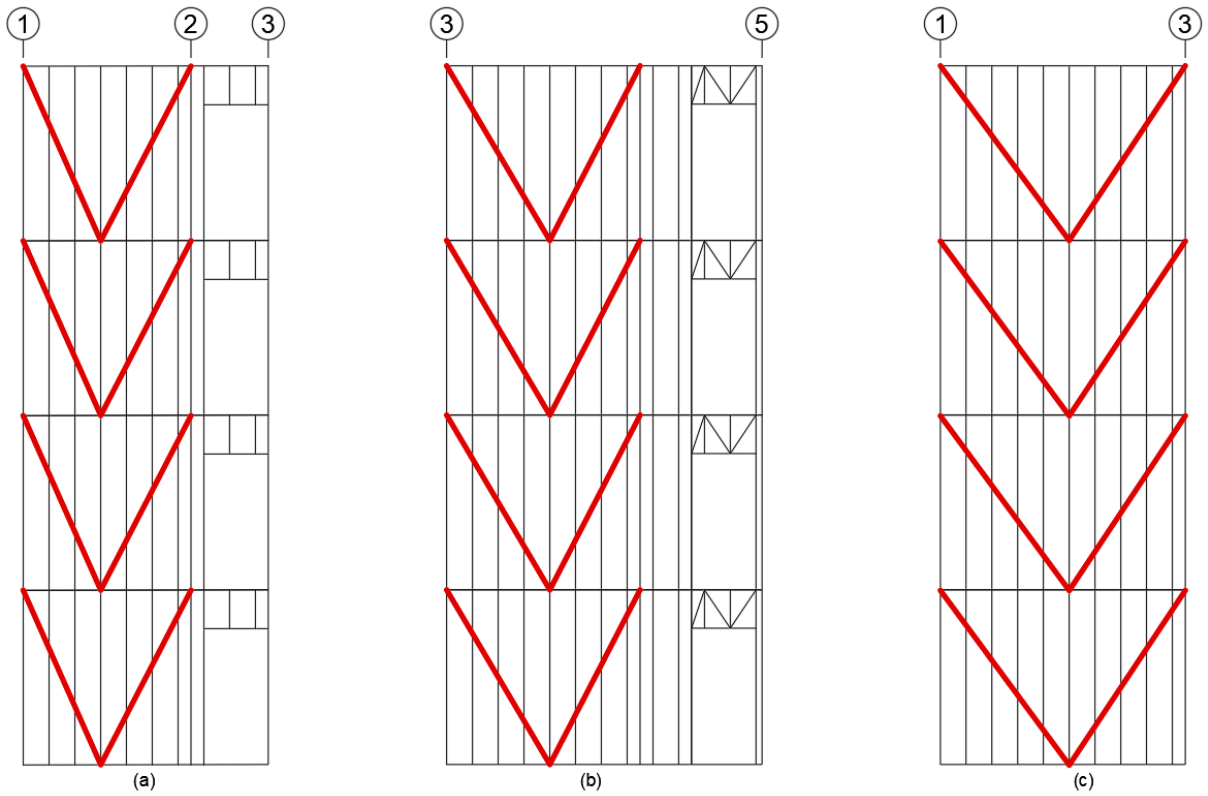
(a) Elevação F/J, (b) Elevação G/I e (c) Elevação H do Contraventamento V
